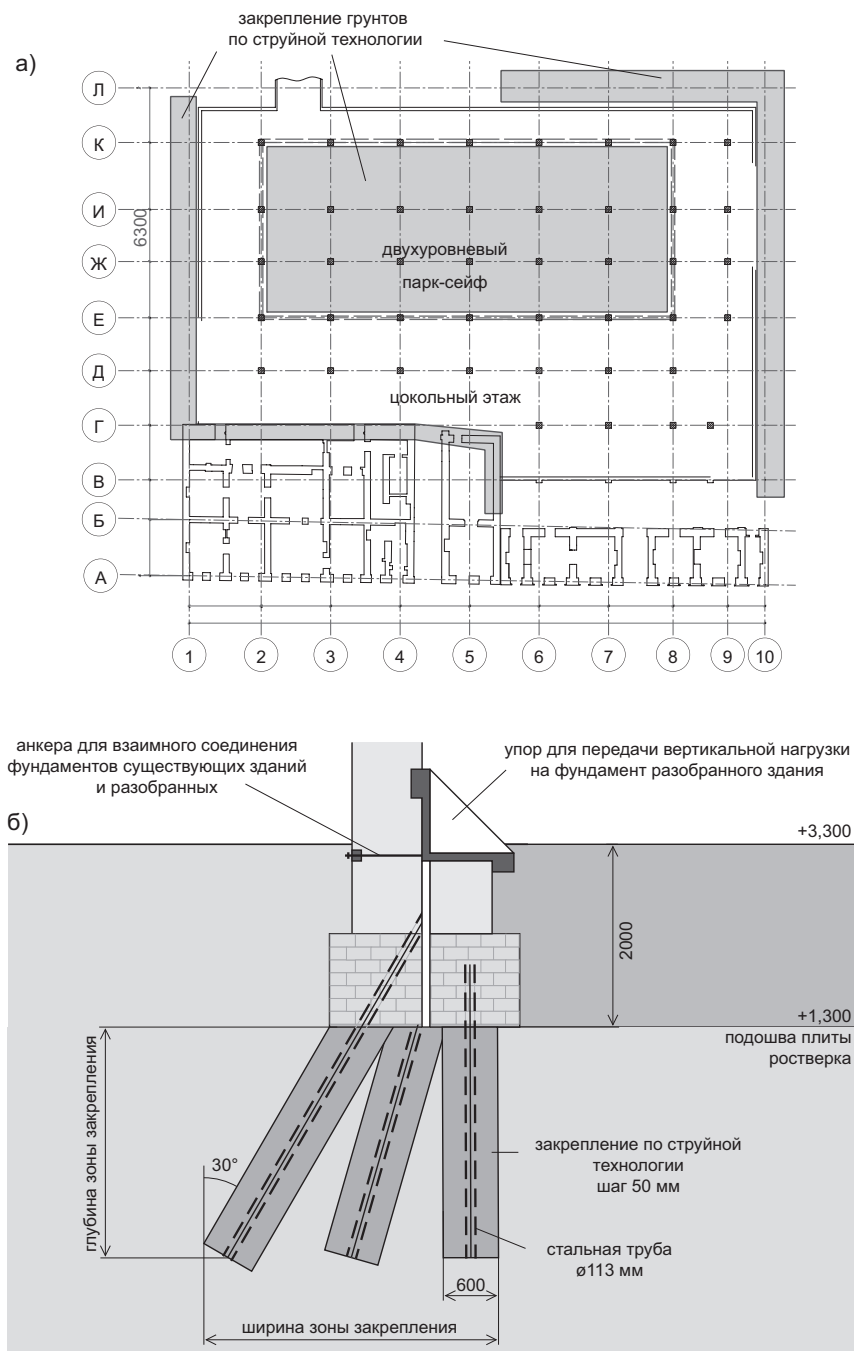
Схема усиления грунта под подошвой фундаментов окружающих зданий с помощью технологии jet grouting: а — план; б — характерный разрез
